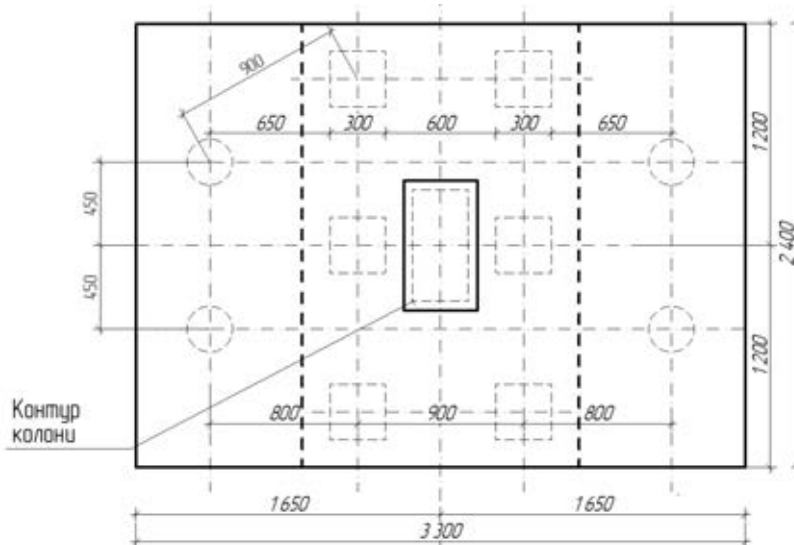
Розрахункова схема підсилення пального фундаменту влаштування буроін'єкційних паль.
